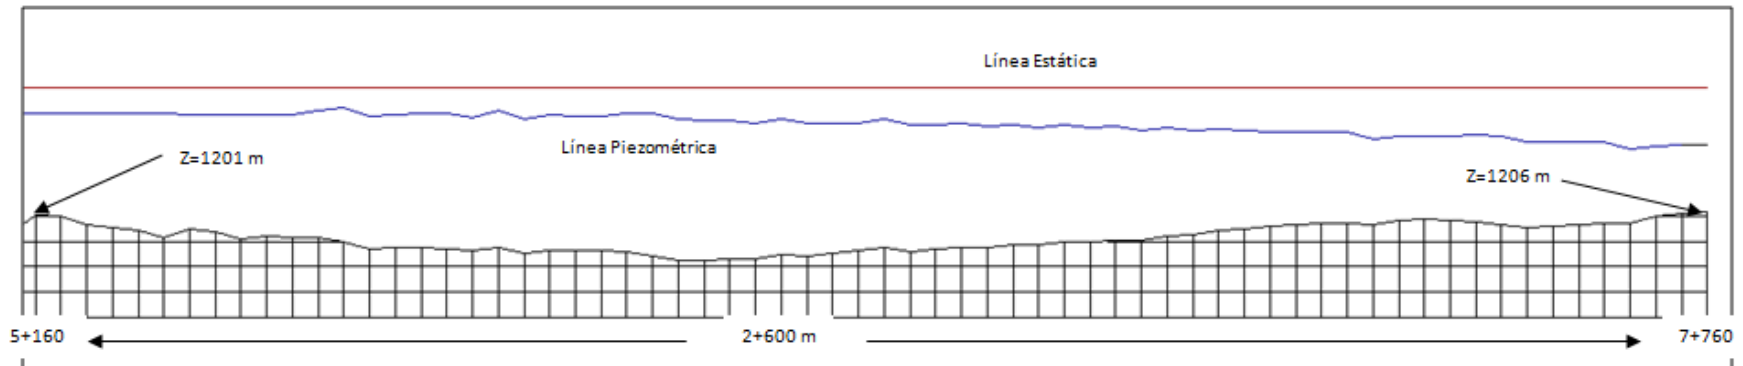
Sección proyectada del perfil de la tubería a analizar.
